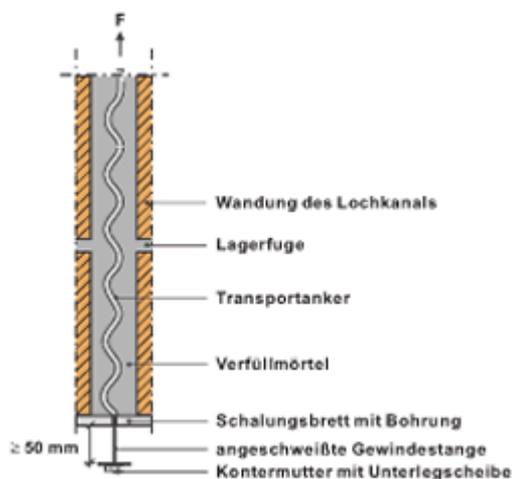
Beispiel eines Transportankers mit angeschweißter Gewindestange zur Befestigung der Messstellen zum Messen des Schlupfes am unbelasteten Ende
